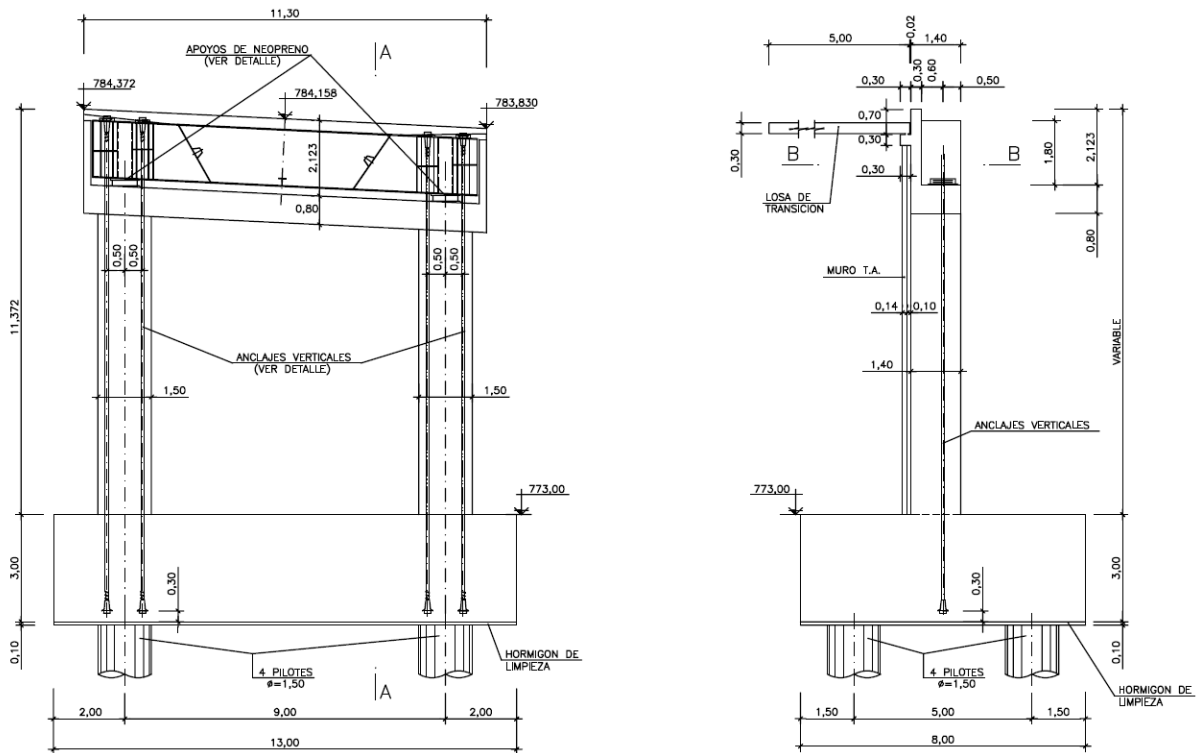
Extracto de los planos de estribos del Proyecto de Construcción de los viaductos.
